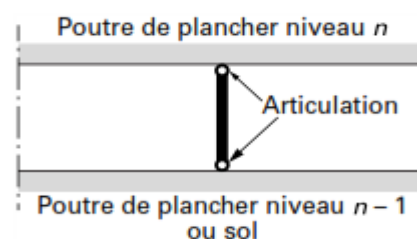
Poteau secondaire, étau, béquille ou chandelle.
